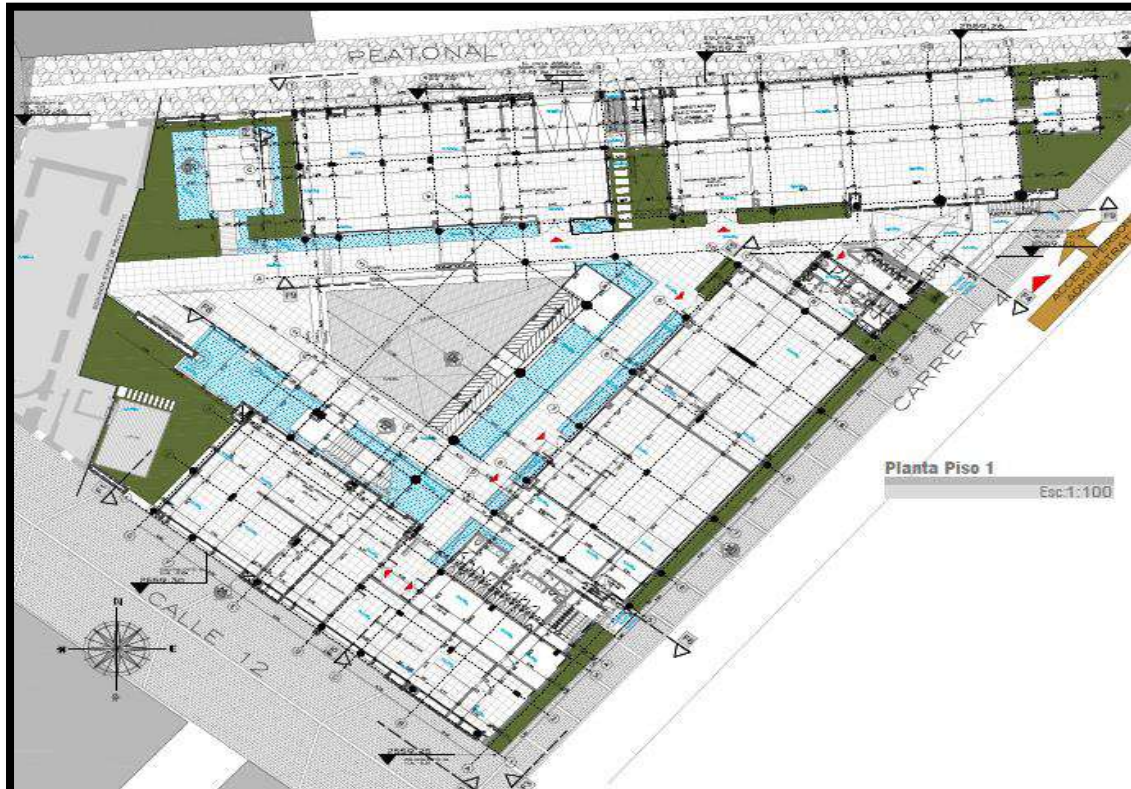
PLANTA PISO 1, SISTEMA ESTRUCTURAL SEDE PARA EL CONCEJO MUNICIPAL, DEL MUNICIPIO DE COTA.
